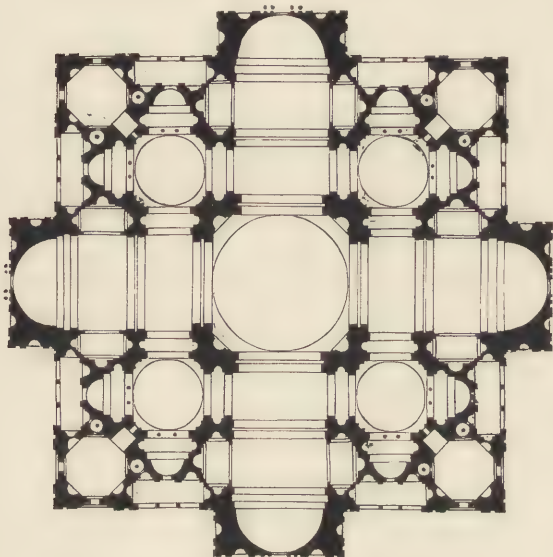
St. Peter. Bramante's erster Grundriss.
